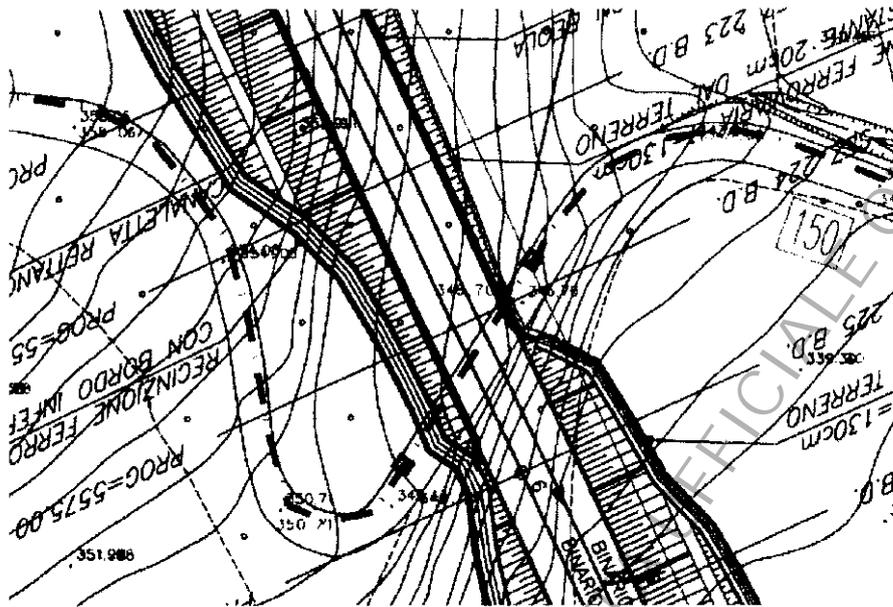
Planimetria dell'interferenza tra la linea ferroviaria e il gasdotto SI 32 029
